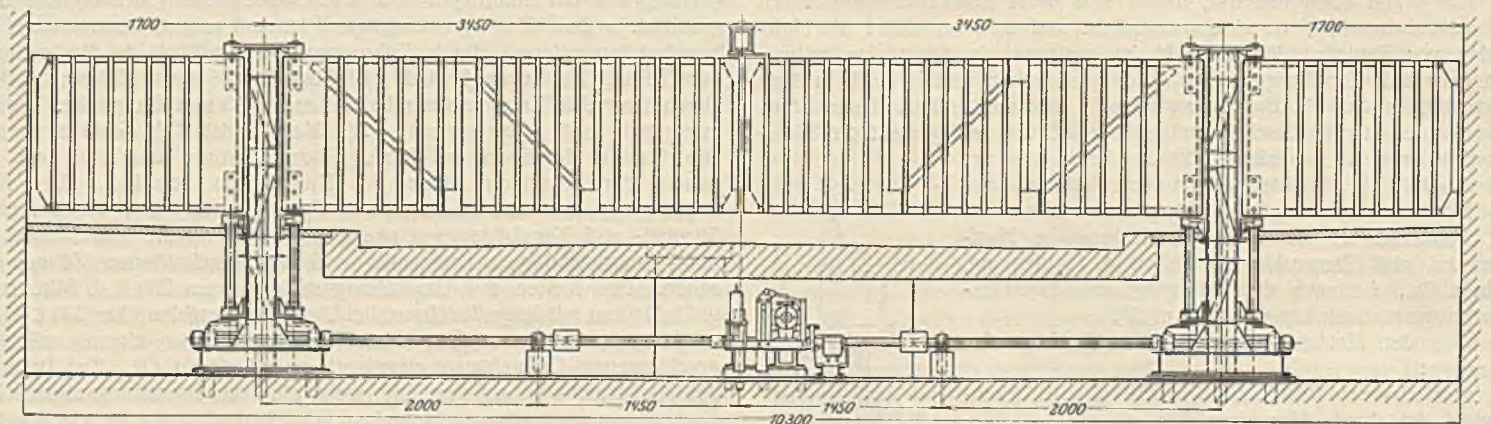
Drehschranken vor Fahrstraße und Fußsteig.
